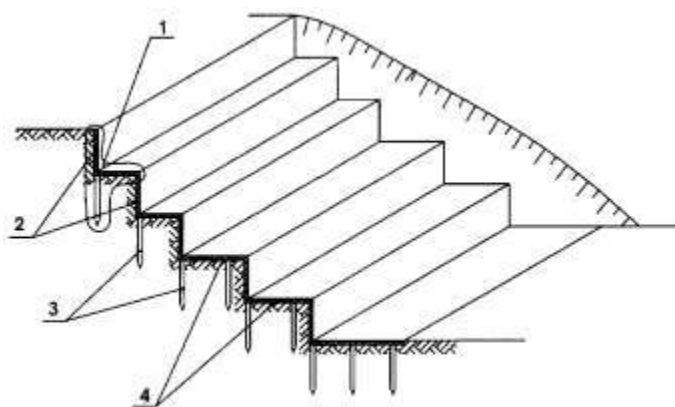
Фундамент здания, вид фундаментных горизонтальных железобетонных плит
